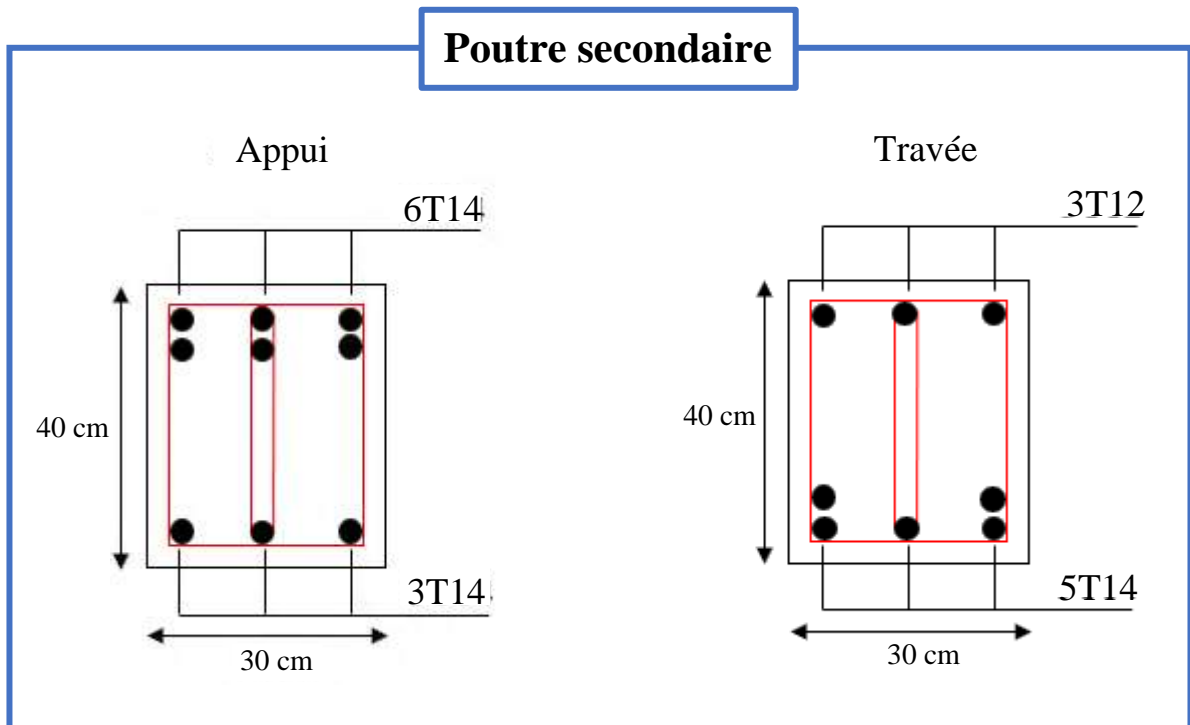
Schéma de ferrailage des poutres secondaire (RPA99/v03).
